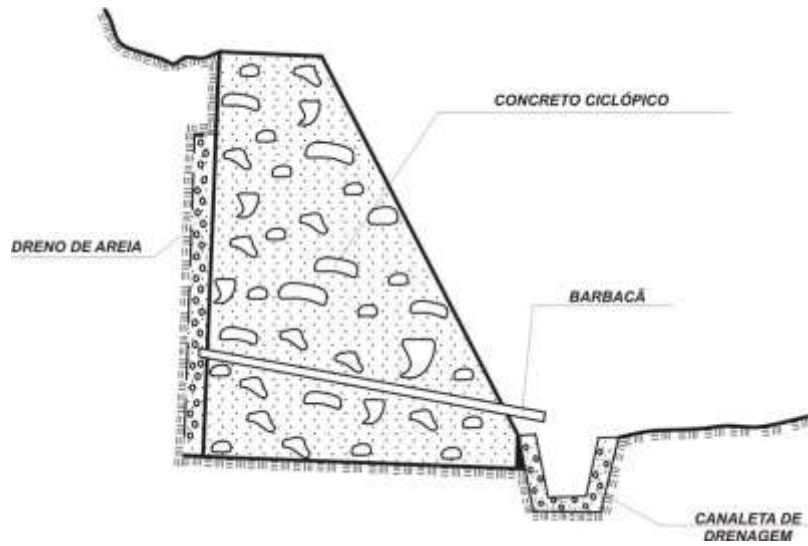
Projeto tipo 13 – Muro de peso de concreto ciclópico.
